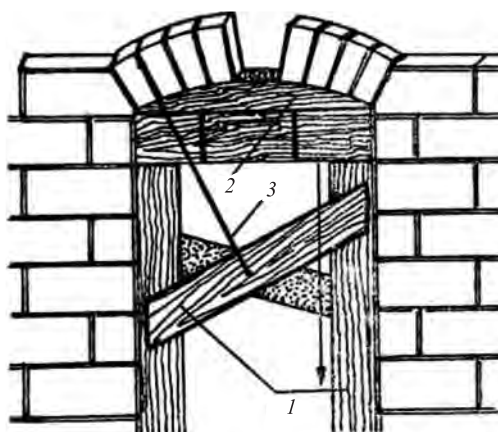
Опалубка с кружалом для кладки арочной перемычки: 1 — элементы опалубки; 2 — кружало; 3 — шнур для контроля радиуса арки
